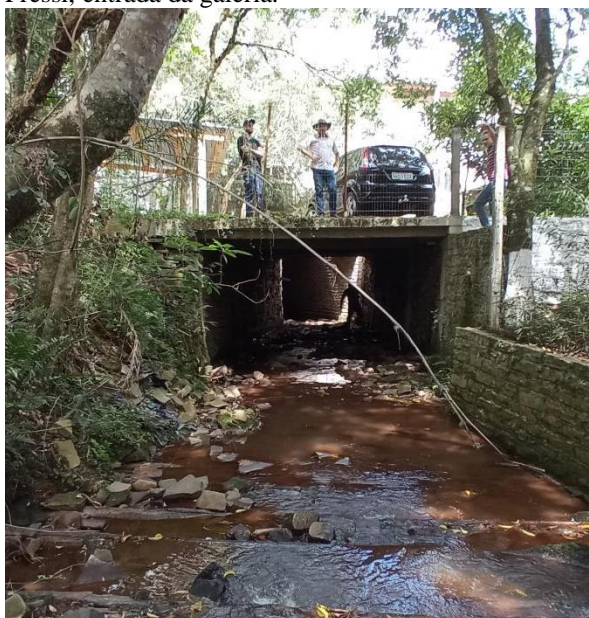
Vista do PA 13, localizado sob a Rua João Pressi, vista da redução da galeria.
